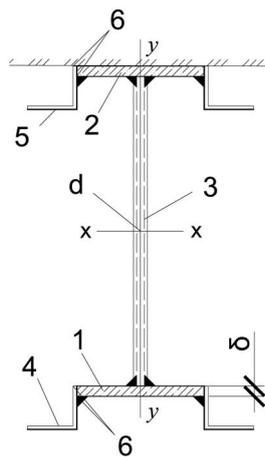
Сечение составной балки с гофрированной стенкой с элементами каркасов термозащитных поясов; обогрев гофростенки с двух сторон
